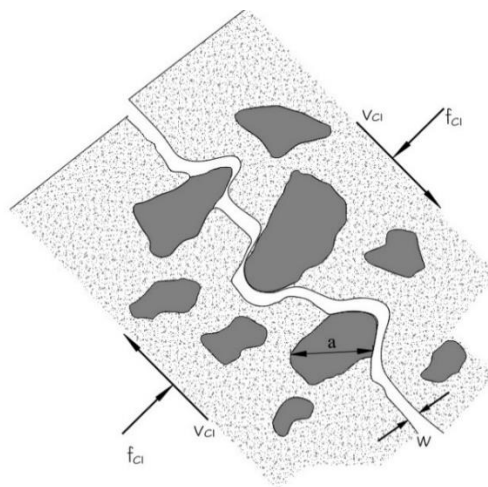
Elemento fissurado - Exemplificação de transferência de esforços entre as faces . Fonte: Adaptado de VECCHIO; COLLINS (1986)
